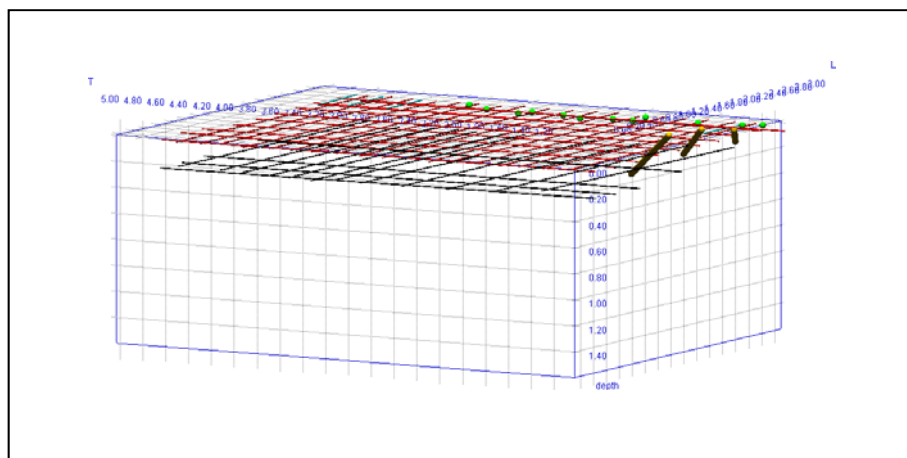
MODELLO 3D, VISTA PROSPETTICA
